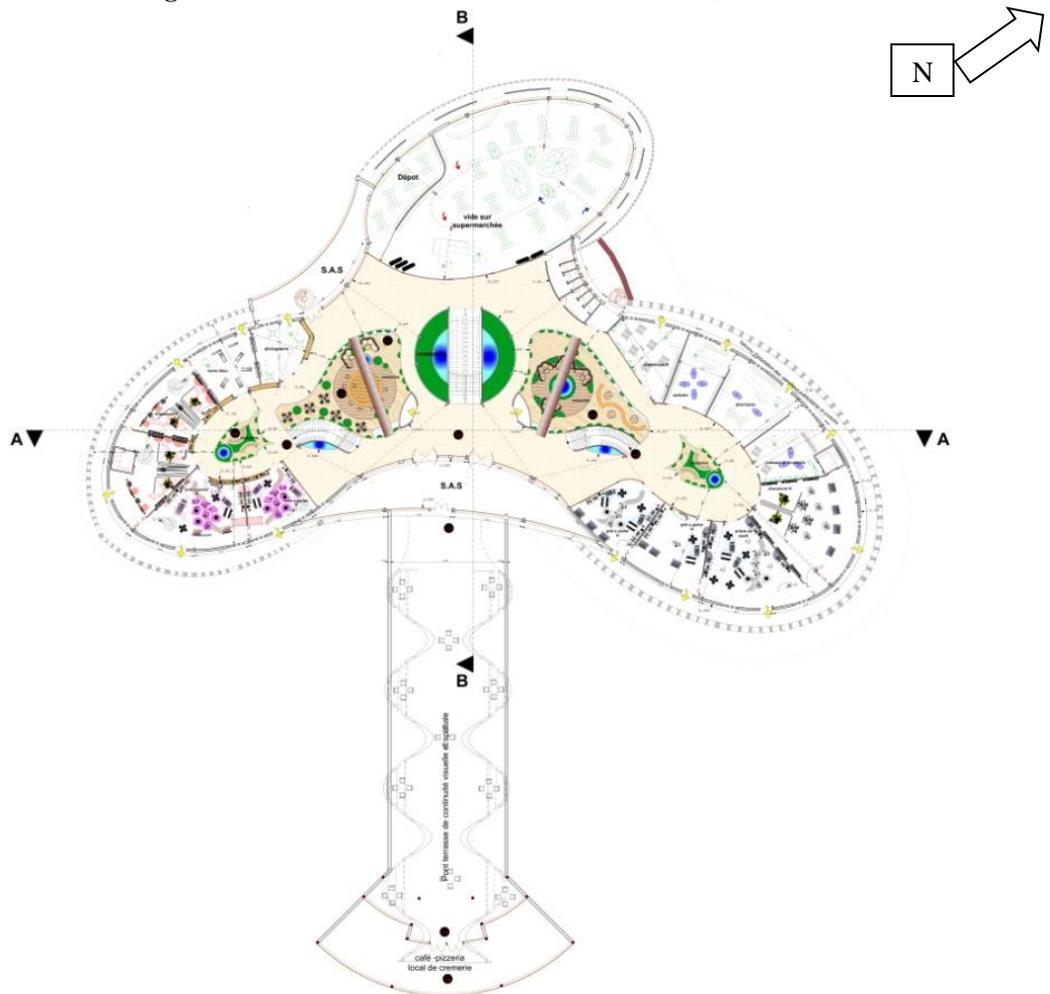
Plan de 1 er étage Source : auteur ,2020
